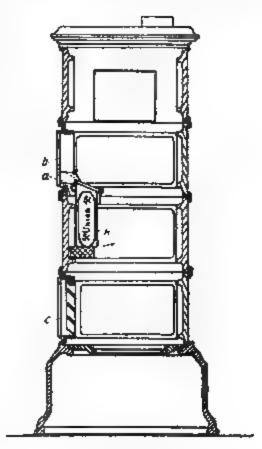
Ofen mit eingebauter Anzündevorrichtung,
